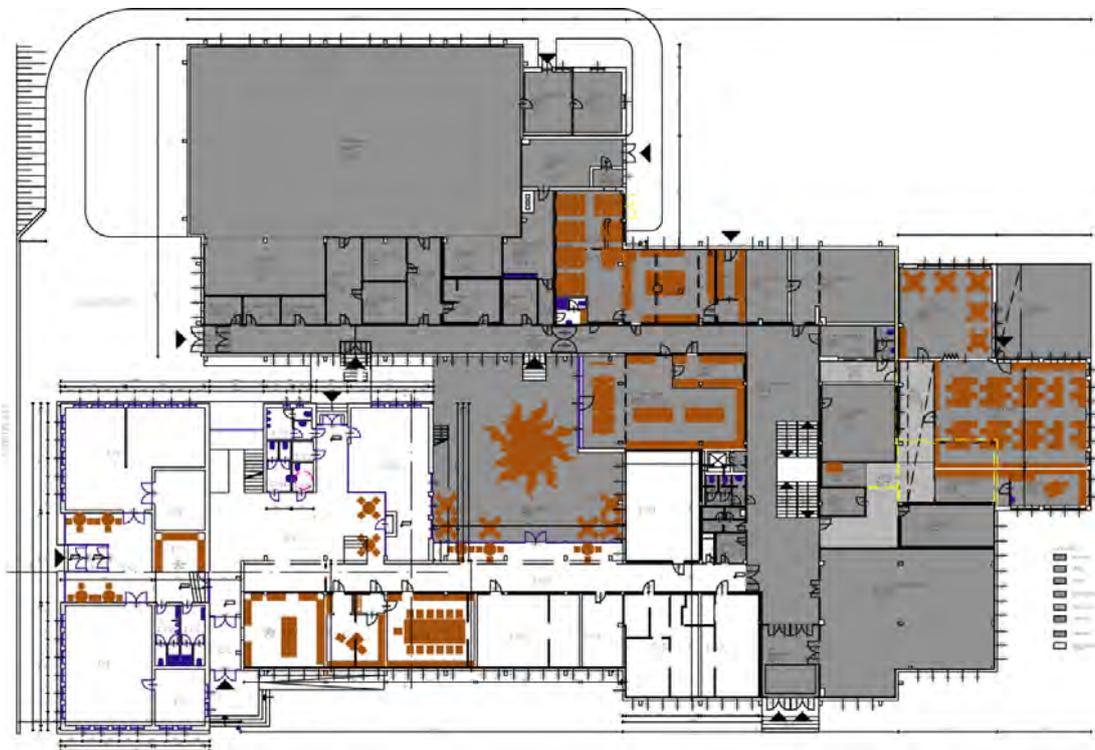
EG Grundriss der ursprünglich geplanten Sanierung und Zubau
